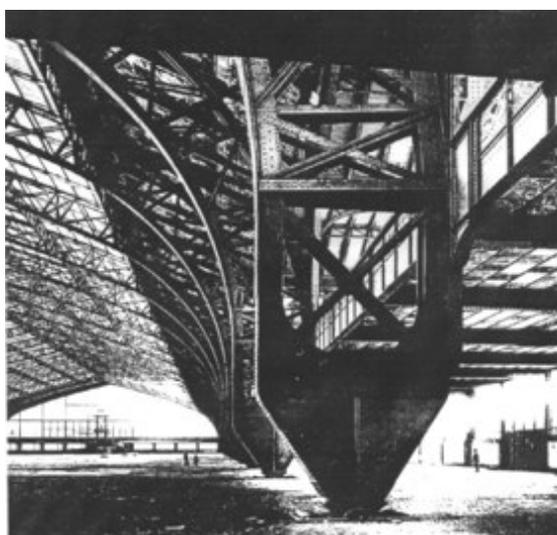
Galeria das Máquinas. Detalhe da Estrutura.
